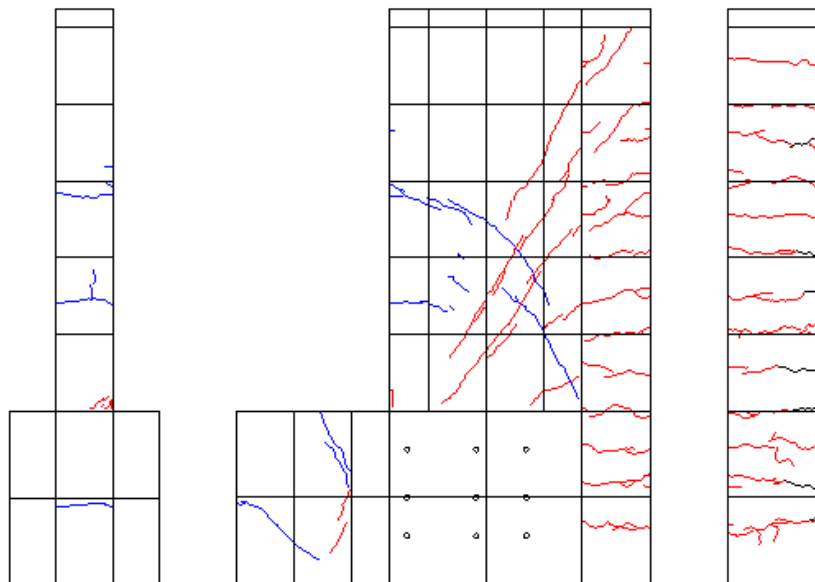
R=-1/133②ひび割れ図
